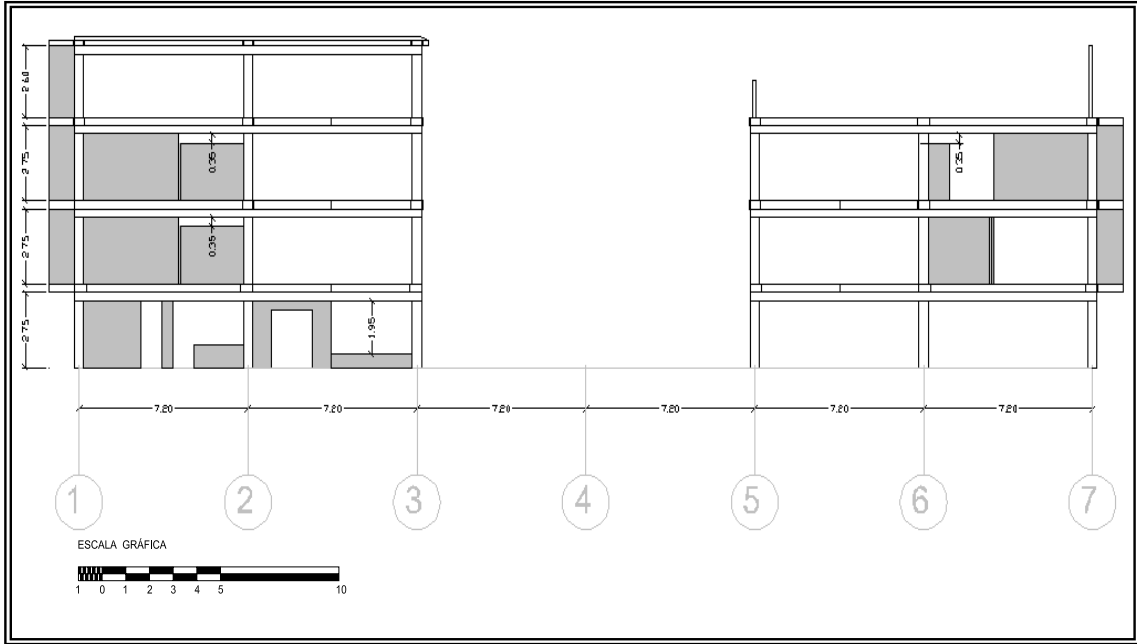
Pórtico C (este-oeste) mostrando las paredes de mampostería y la longitud efectiva de columnas
